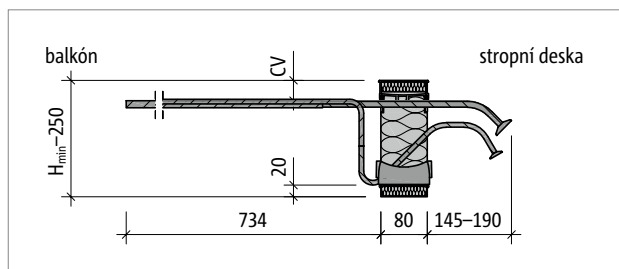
Schöck Isokorb® T typ KL-U-M4: Půdorys prvku
